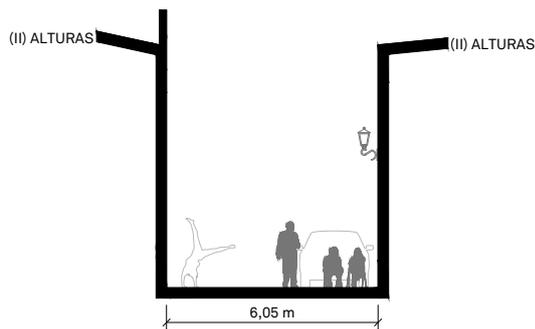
y 130. Calle Ribarroja. Elaboración propia.
